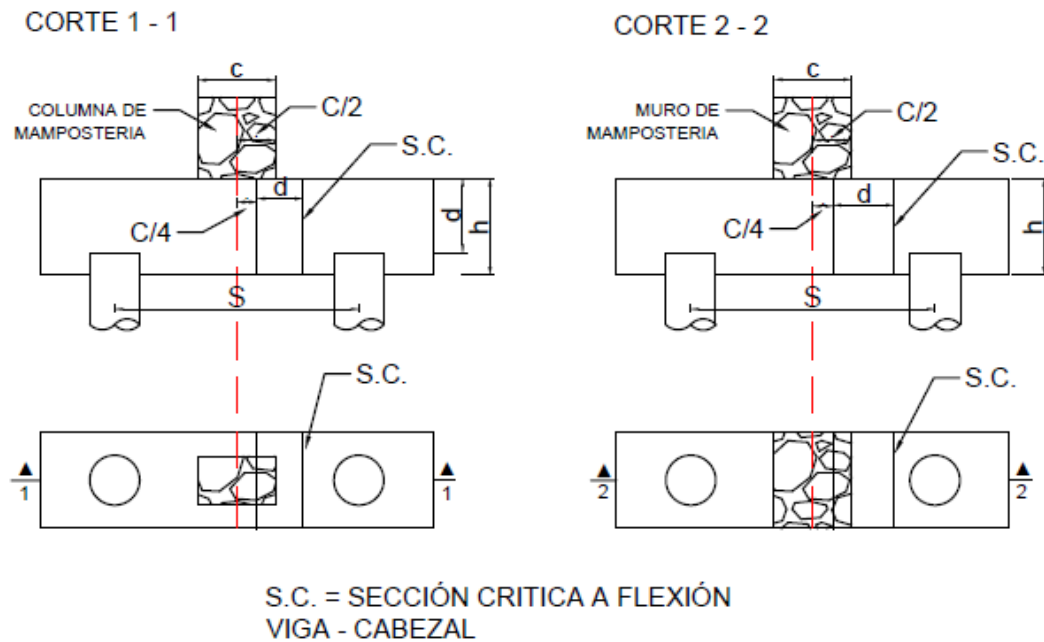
Esfuerzos cortantes en la columna o muro de mampostería.
